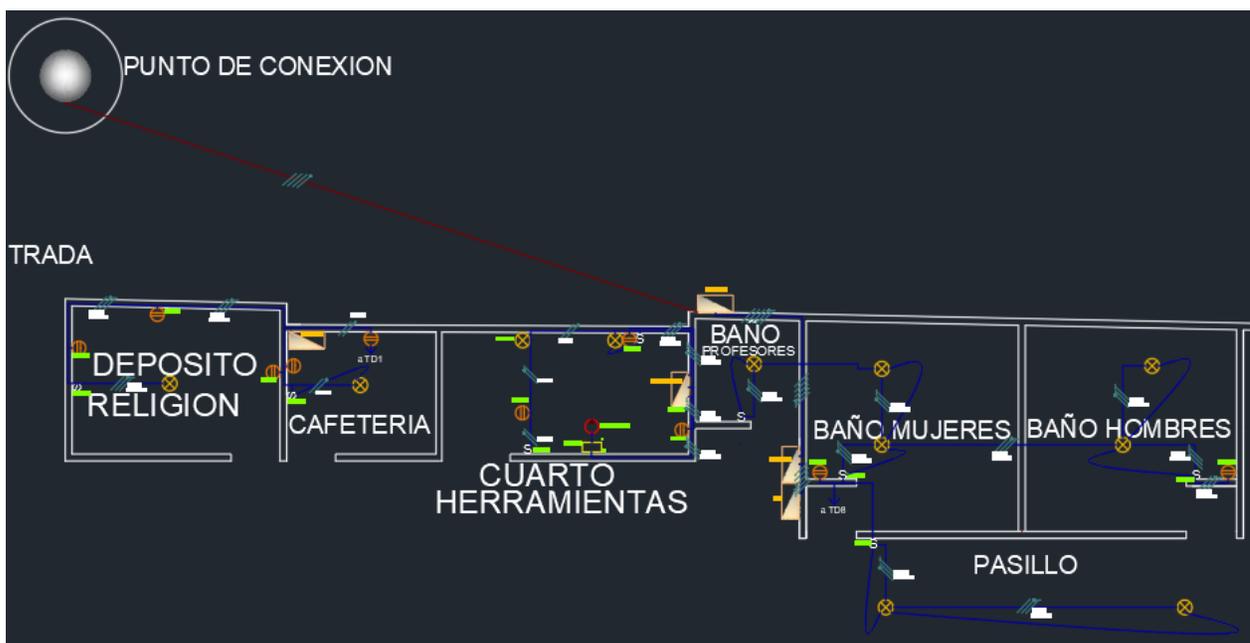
Segundo piso de plano arquitectónico trazado en AutoCAD
